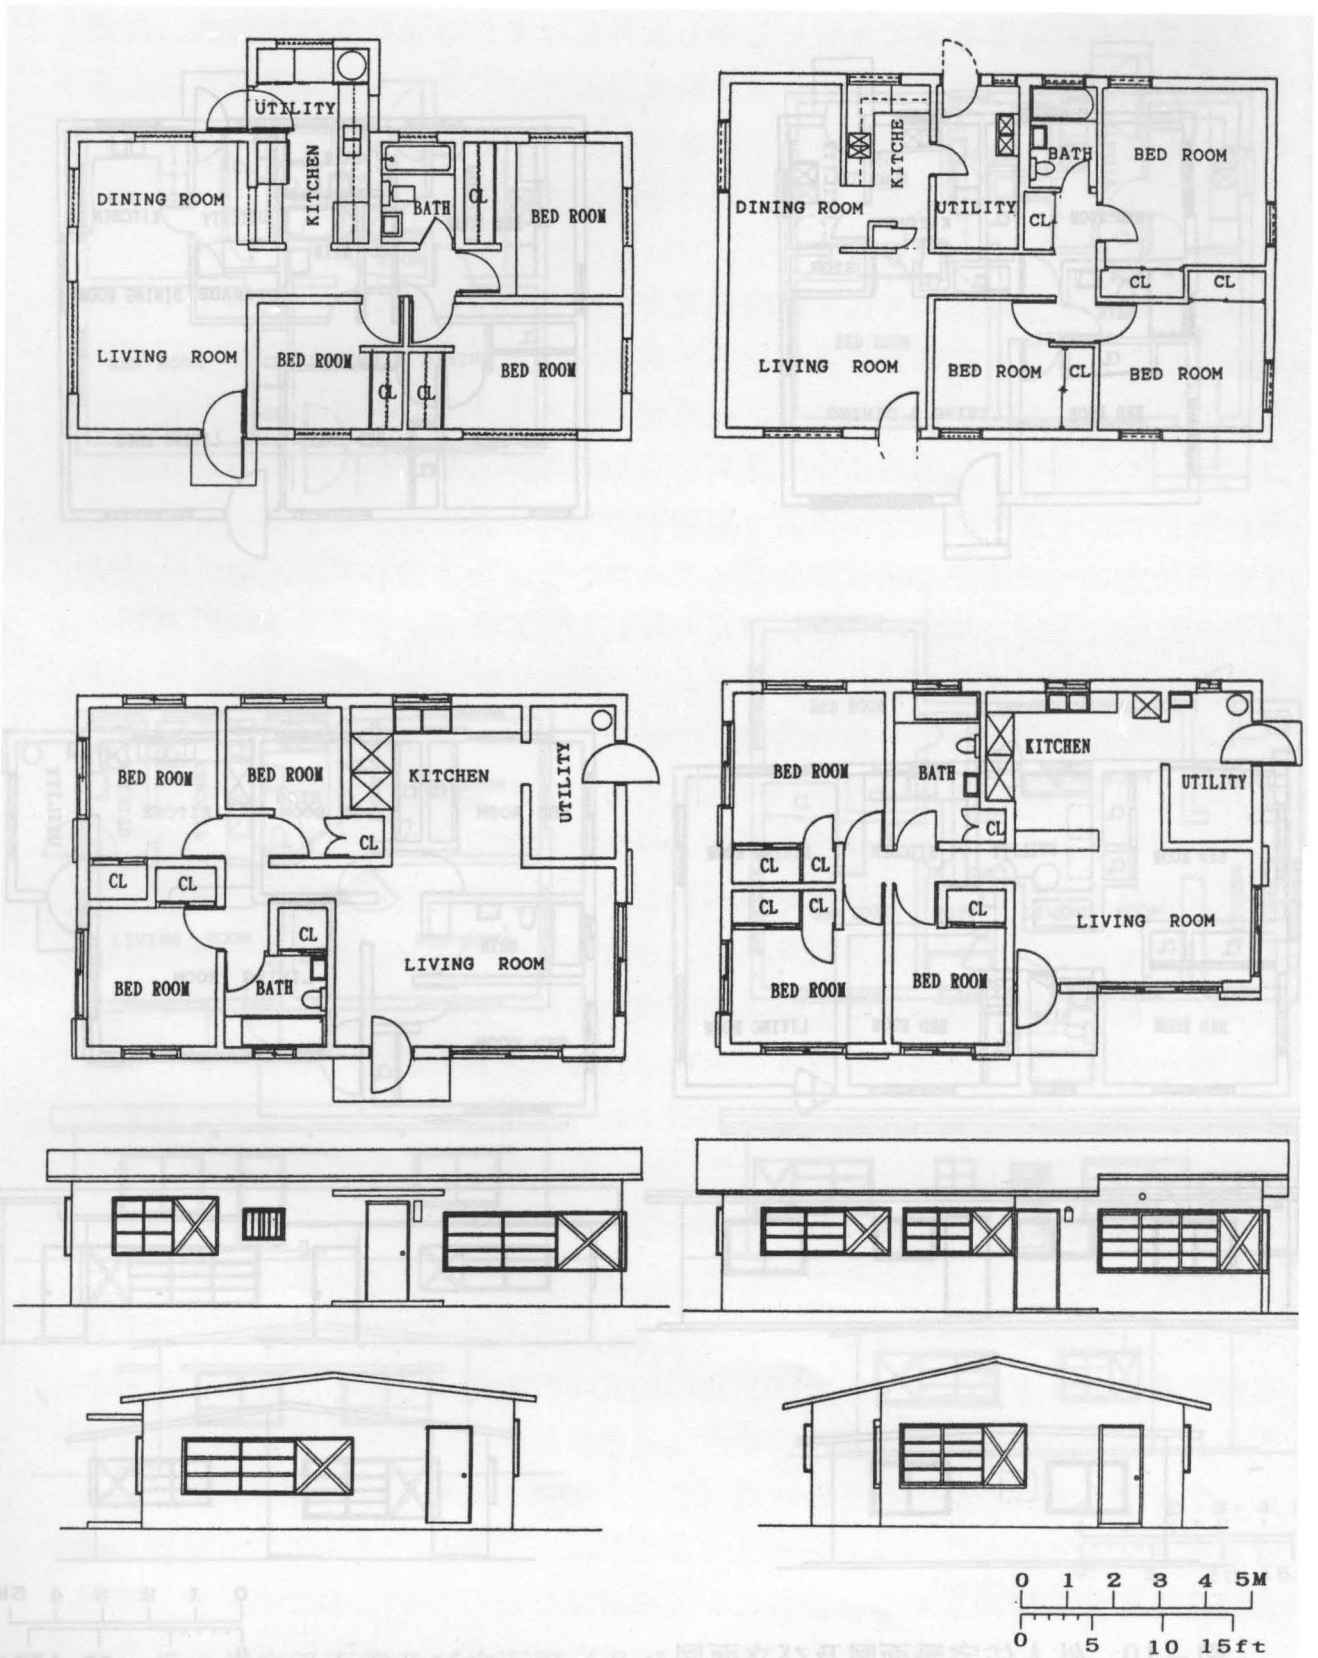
外人住宅平面図及び立面図（3ベッドルームタイプ）
